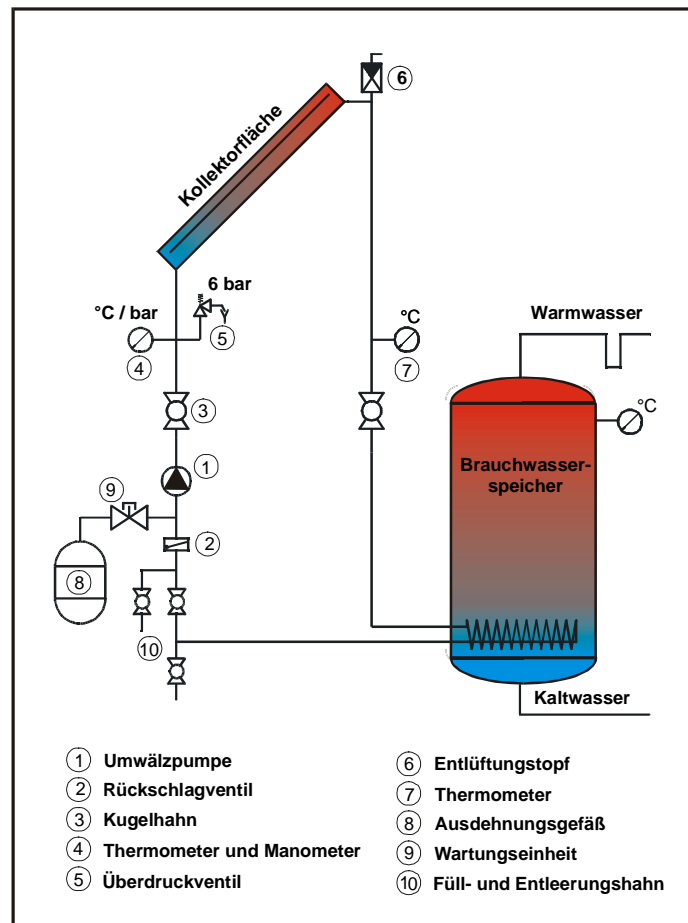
Hydraulikschema einer thermischen Solaranlage zur Brauchwasserbereitung
